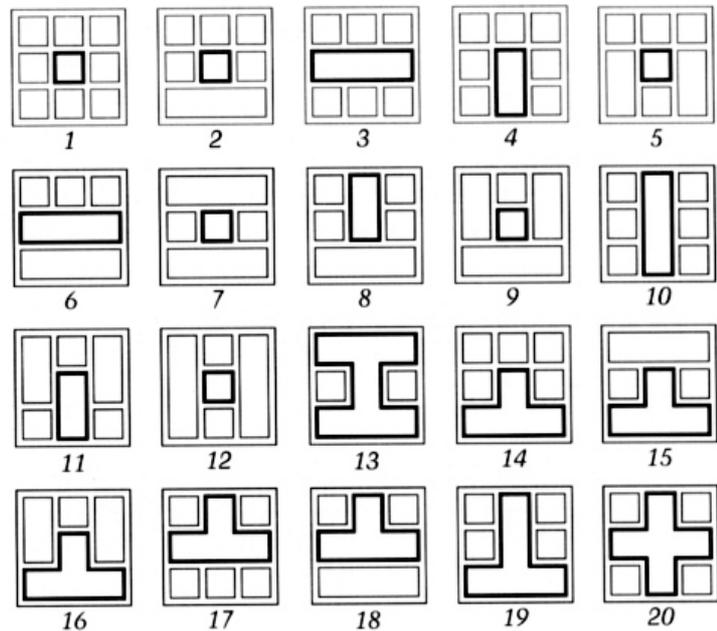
Grundrissvarianten einer Küche durch das System LOOS [Flemming 1990]
